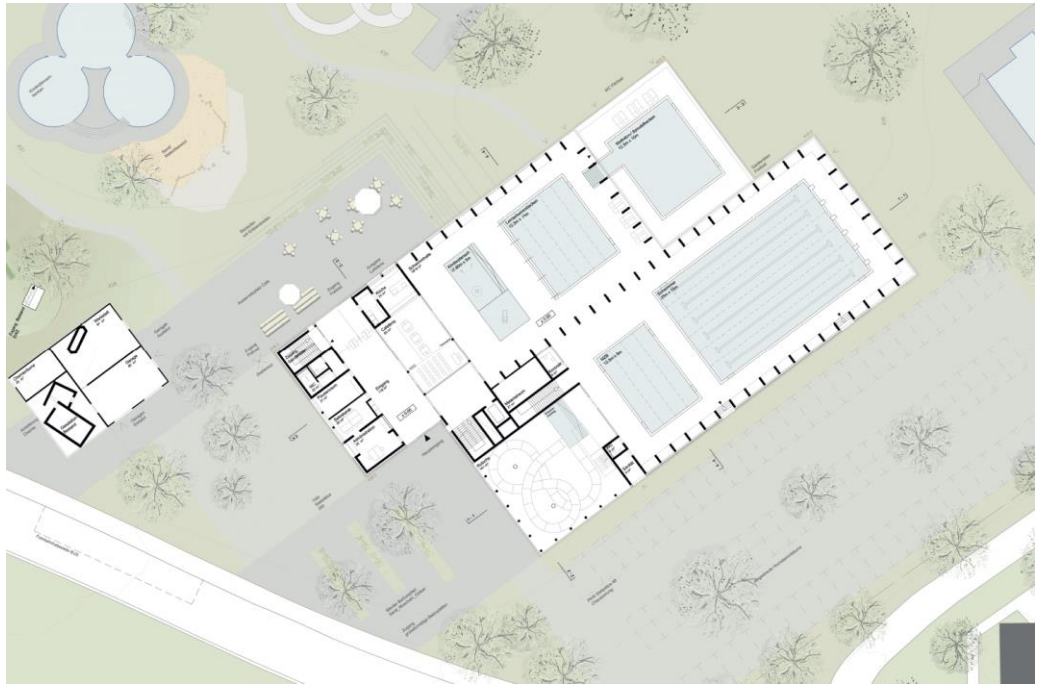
Grundriss Erdgeschoss (ohne Massstab)
